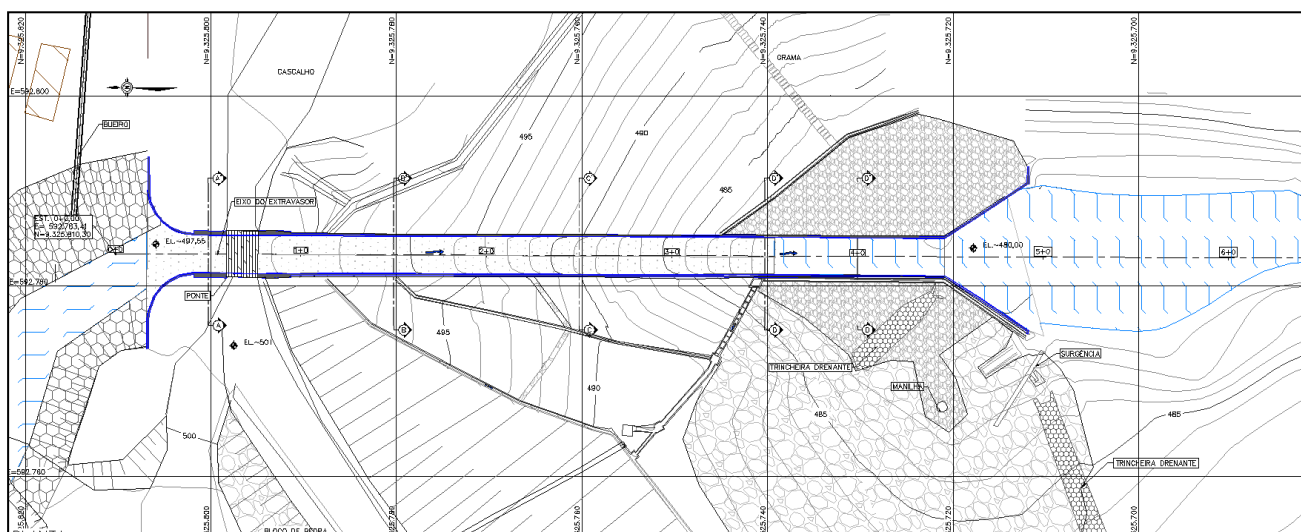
Sistema extravasor da Barragem Estéril Sul – Vista em planta.
